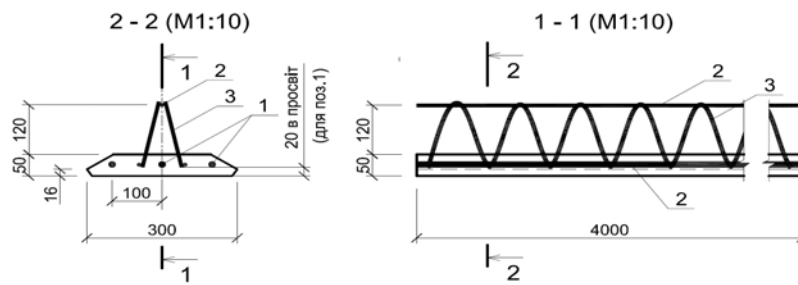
Конструкція плити опалубки ПО-1 (ПО-2)
